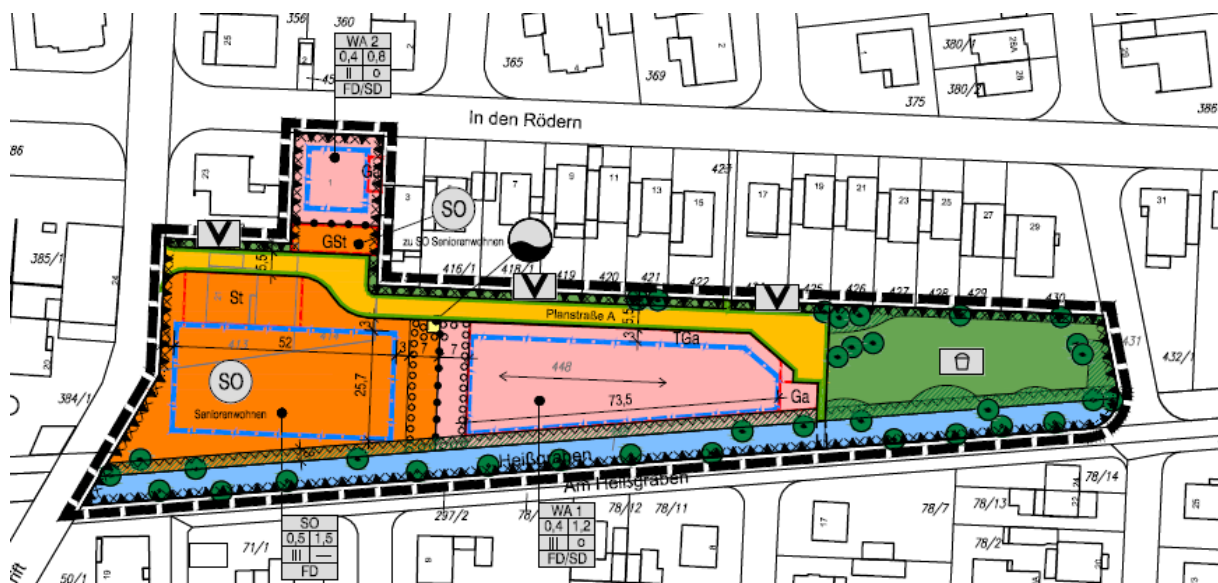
1. Änderung Bebauungsplan "Auf dem Zehnthöbel"
